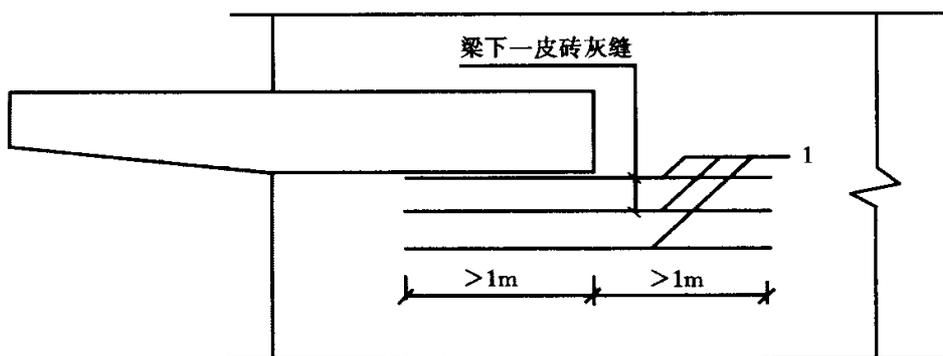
顶层挑梁末端钢筋网片或钢筋
